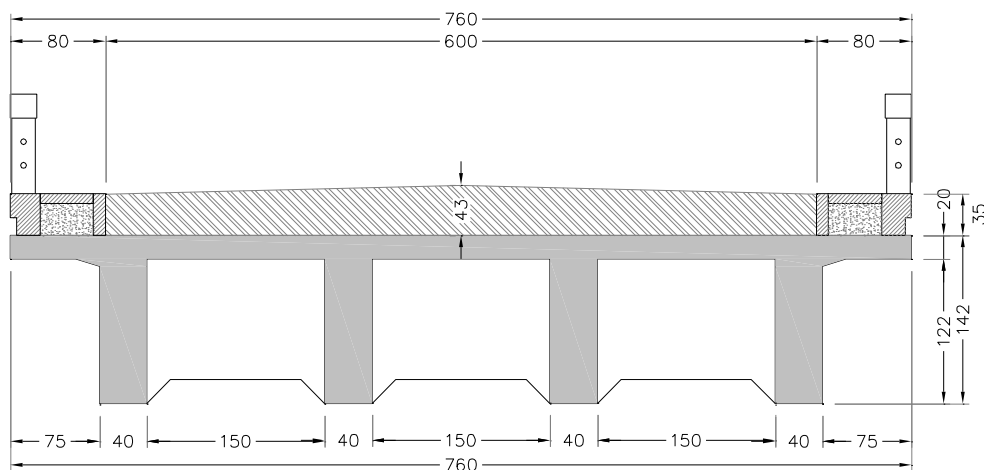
Sezione trasversale corrente dell'impalcato
